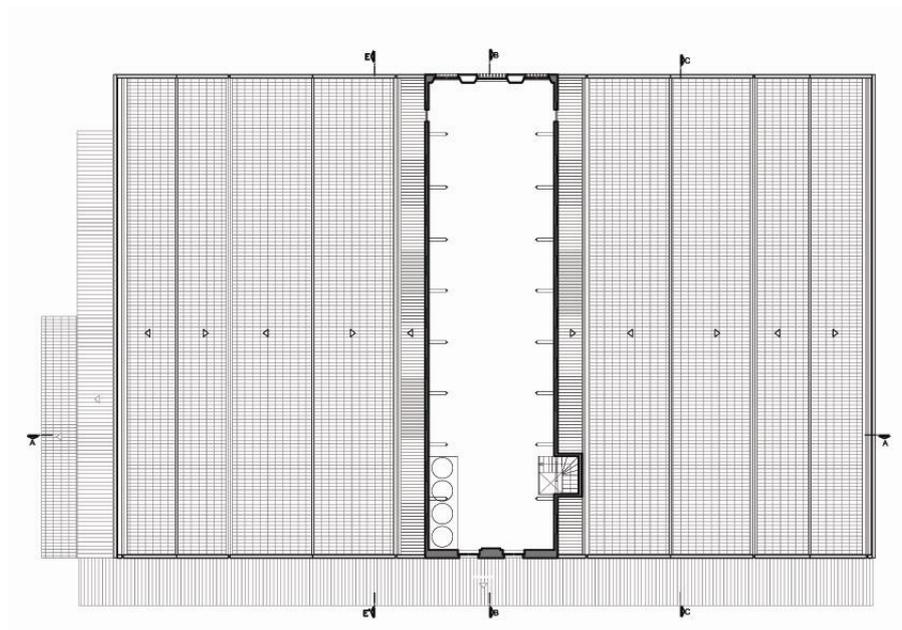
Planta de Cadastro da Mansarda – Situação antes da intervenção
